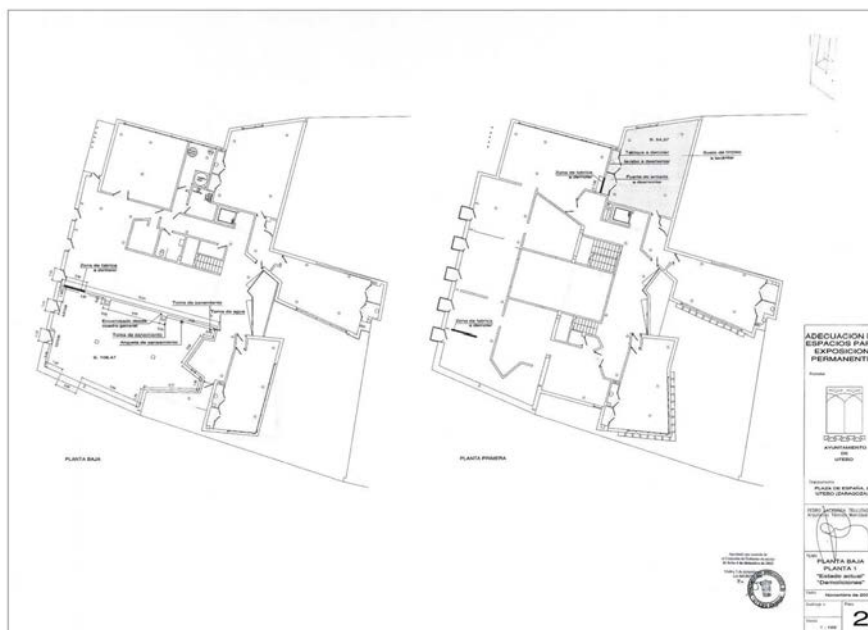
Actuaciones previstas en la adecuación expositiva de las plantas baja y primera
